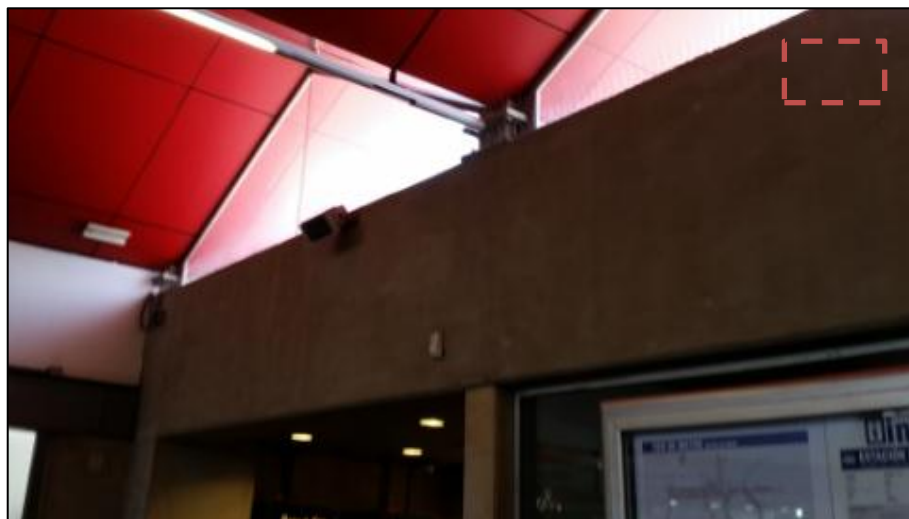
En Techo con Mástil Horizontal Of. Jefe Estación
